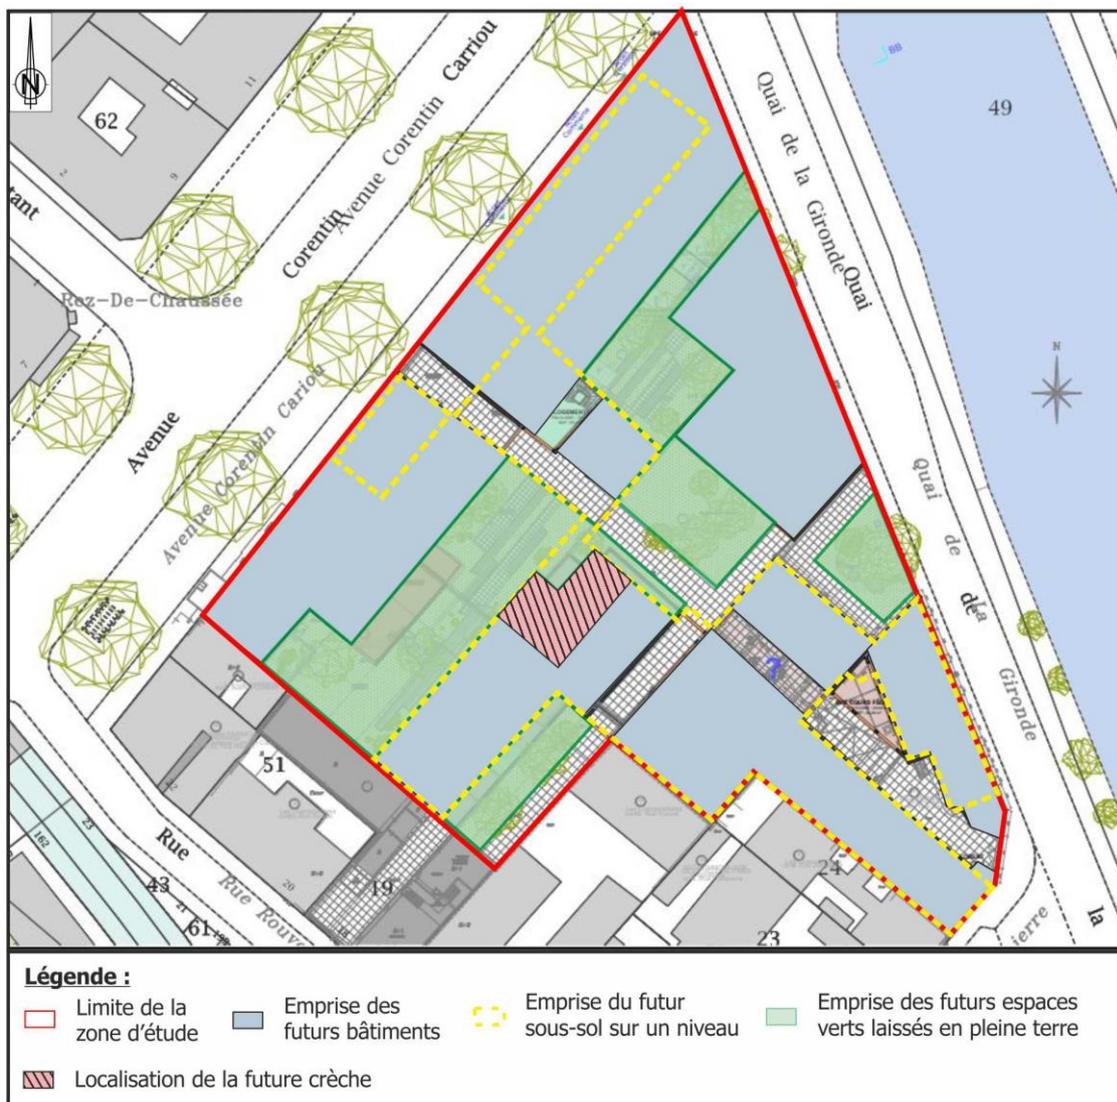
Plan Projet – FAISA GENERALE du 13/04/2023
